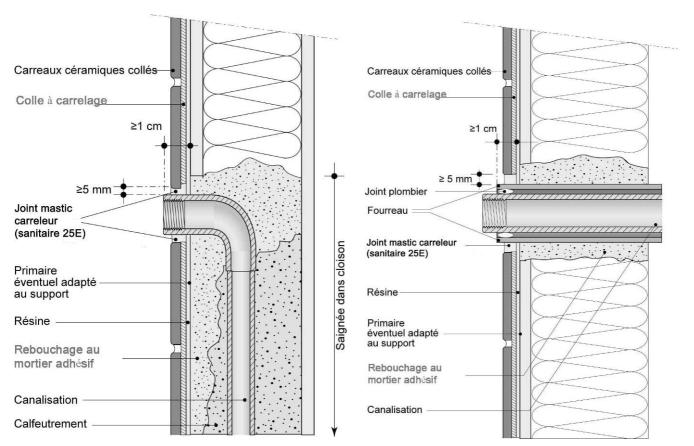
Traitement d'une canalisation encastrée (sans fourreau) en paroi verticale ; exemple d'une cloison en plaques de parement en plâtre.
